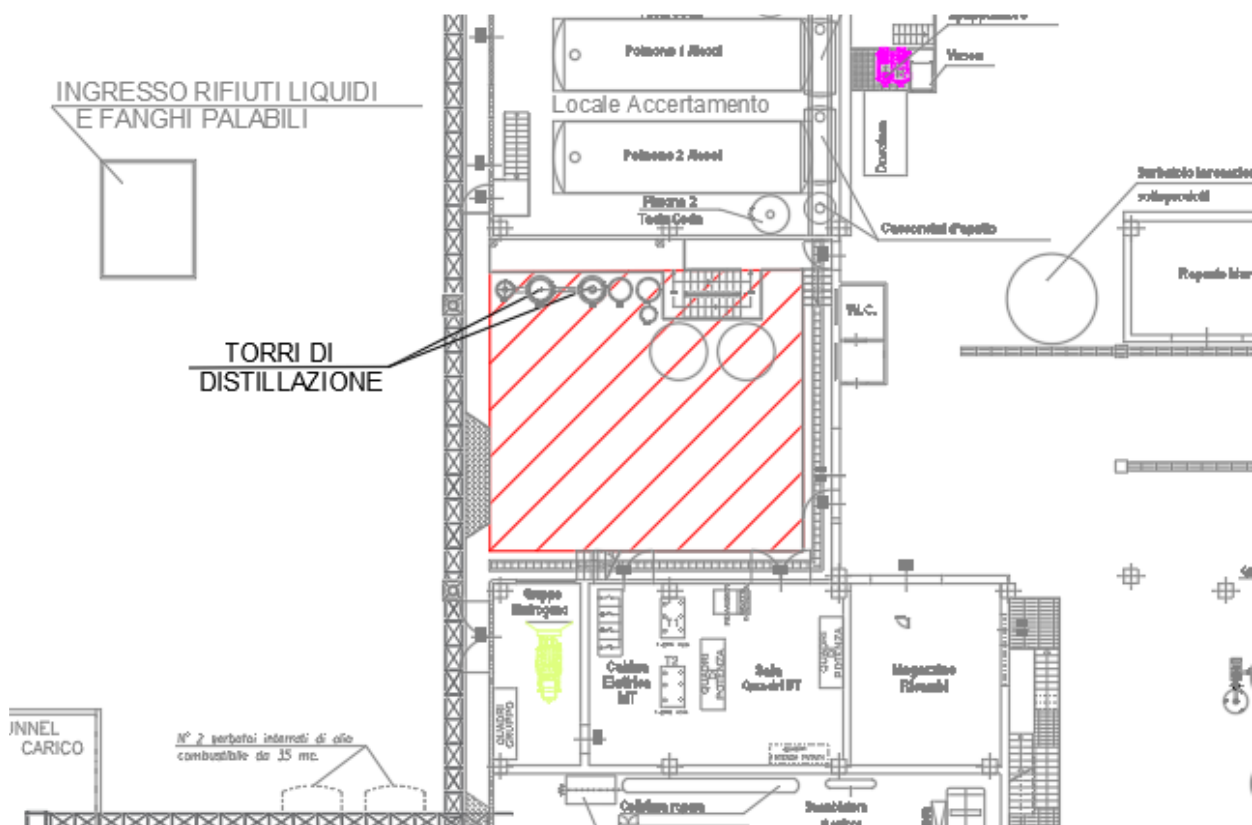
Localizzazione in planimetria dell'impianto di distillazione
